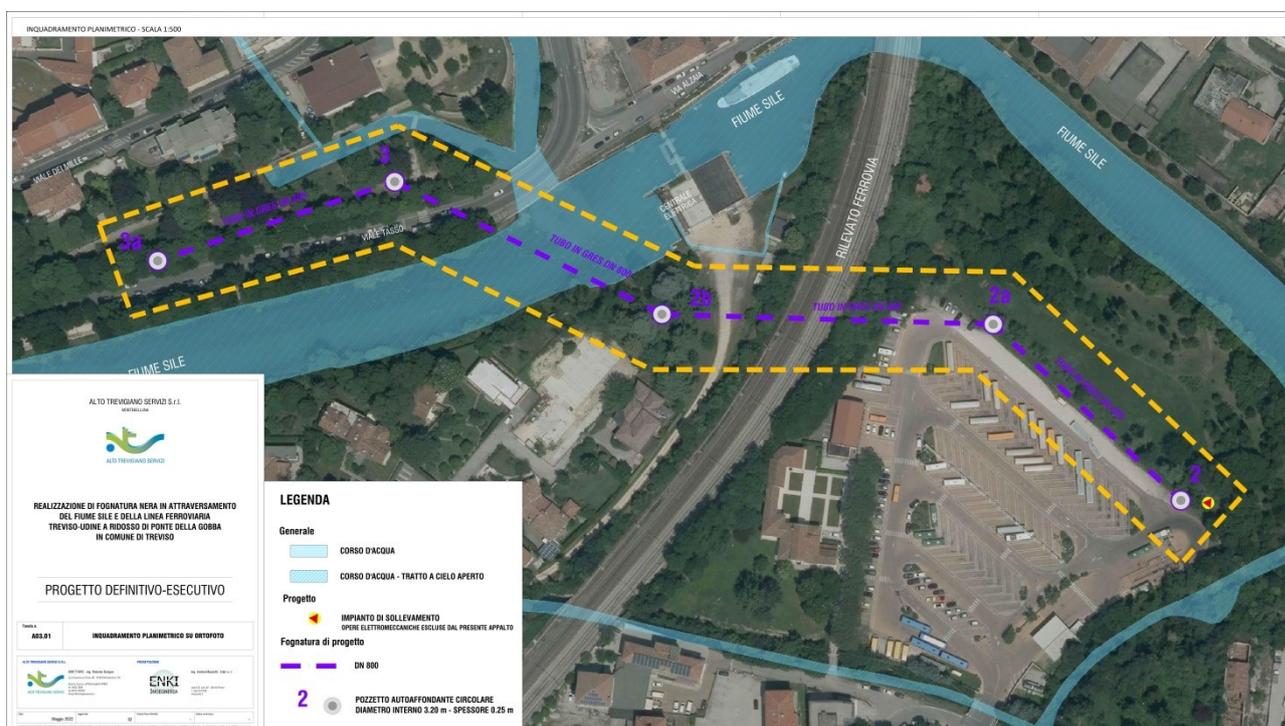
Inquadrimento planimetrico dell'opera da satellite.
